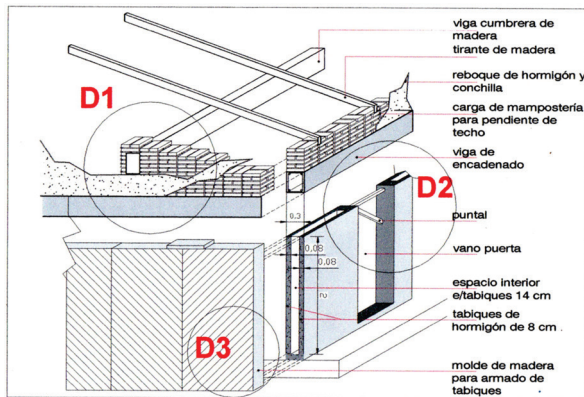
Desglose de los principales elementos que conforman el sistema constructivo de la vivienda. Elaboración propia.
